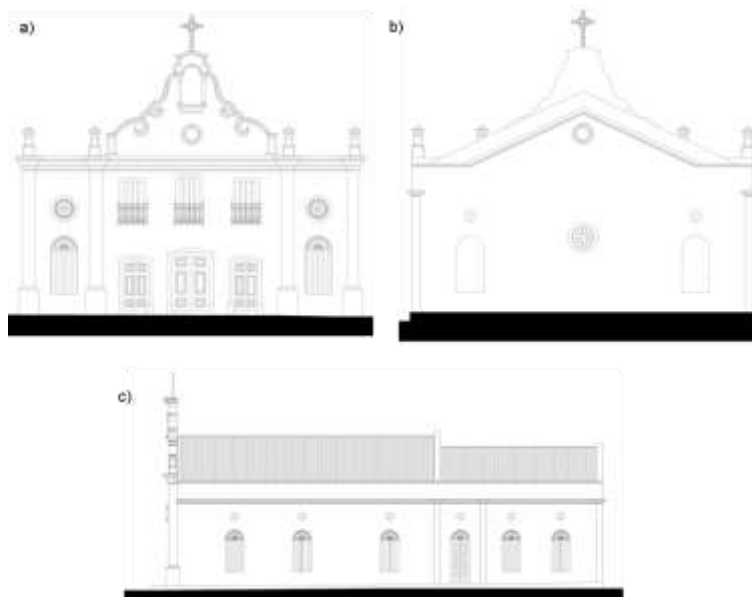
Cortes das fachadas da Igreja do Rosário (a) fachada principal (b) fachada fundo (c) fachada lateral
